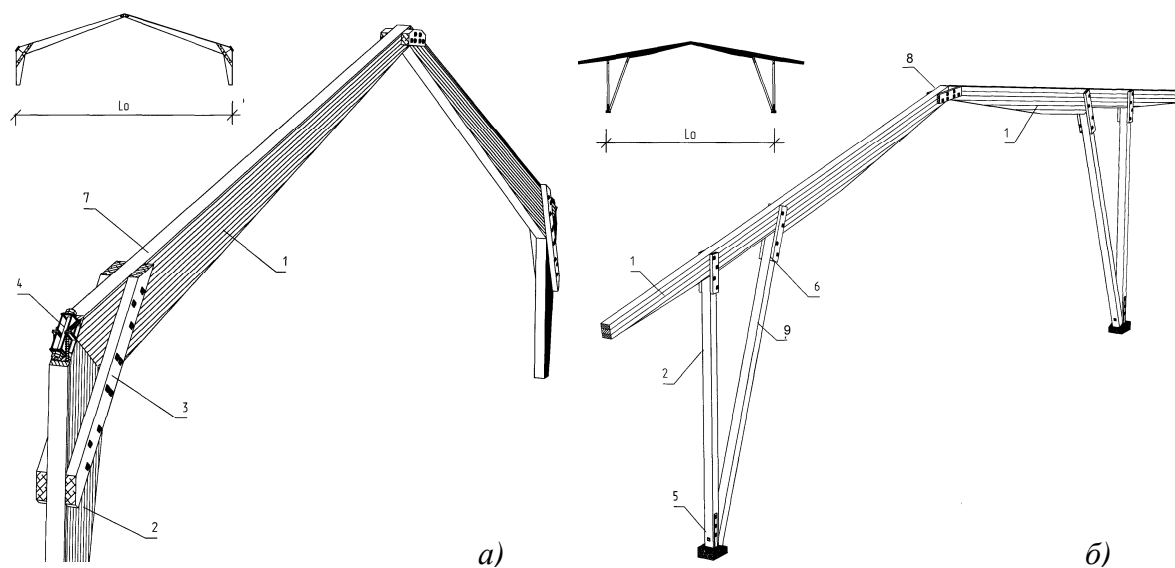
Двухподкосная рама (а) и рама с внутренними опорными подкосами (б): 1 – ригель рамы; 2 – стойка рамы; 3 – дощатый подкос на стяжных болтах; 4 – монтажный стык; 5 – фундамент с анкерными пластинами; 6 – деревянные накладки с овальными отверстиями; 7 – защитная доска на клею; 8 – коньковый узел с деревянными накладками; 9 – цельнодеревянный или клееный подкос
